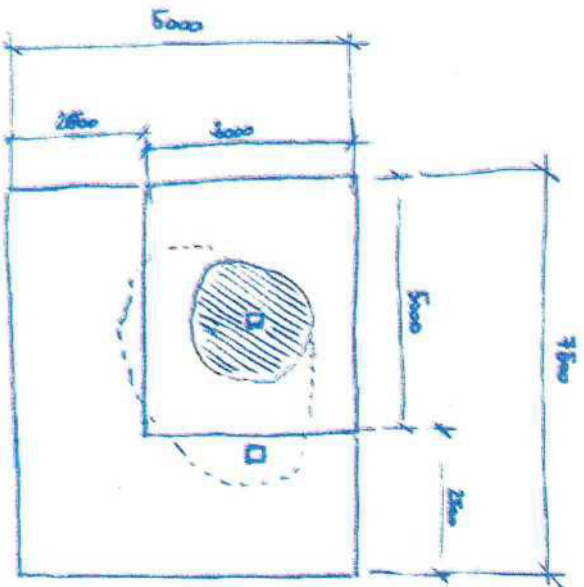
Detail zvětšení propadu – pohled severní stěna
